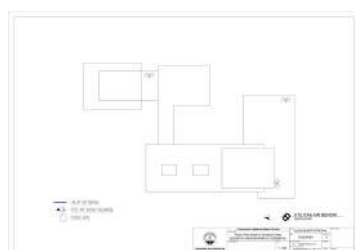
Utilitas Air Bersih *Layout Plan
